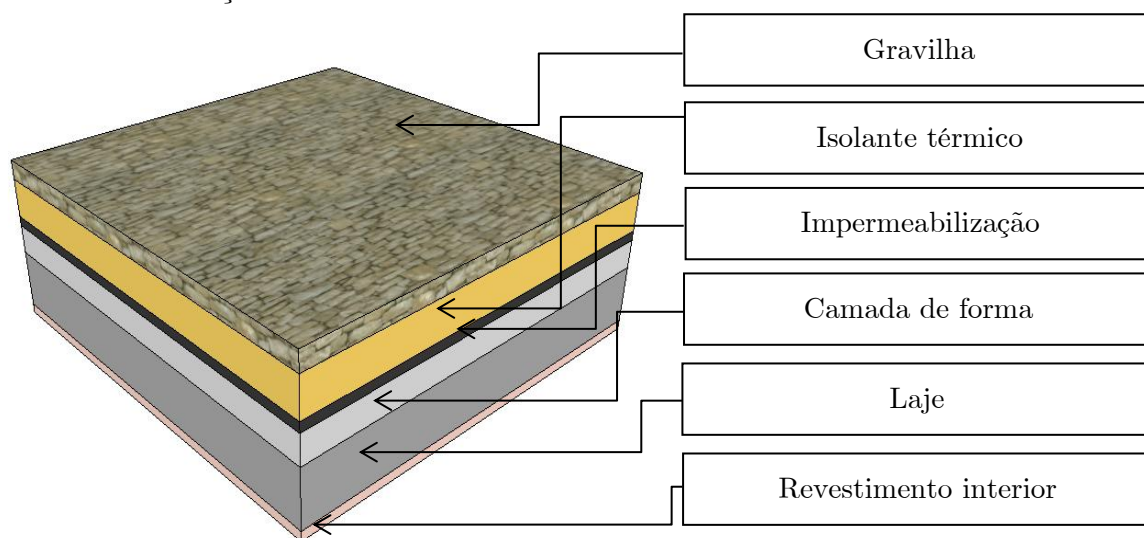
Esquematização de um sistema de isolamento térmico aplicado sobre uma cobertura horizontal em terraço
